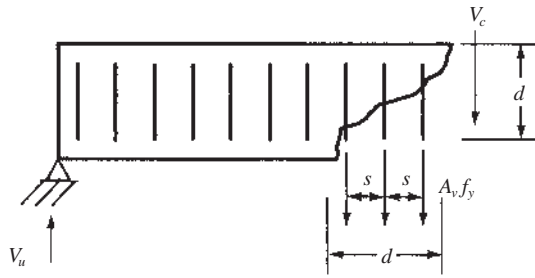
Viga con grieta diagonal y estribos verticales.
